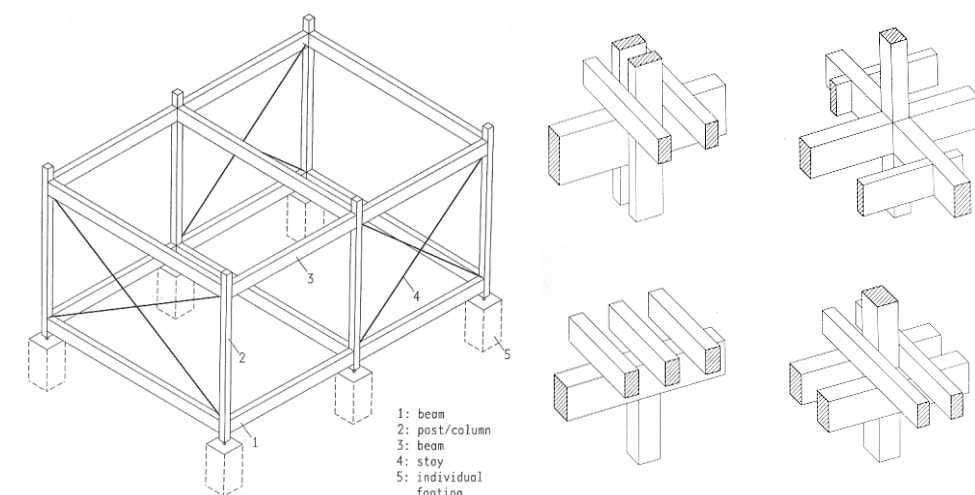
Porticados de pilar viga com quatro variações: Pilares e vigas secundárias duplicadas, Vigas contra pilar, Viga sobre pilar, Pilar contínuo e vigas primárias e secundárias duplicadas (Steiger, 2007).
